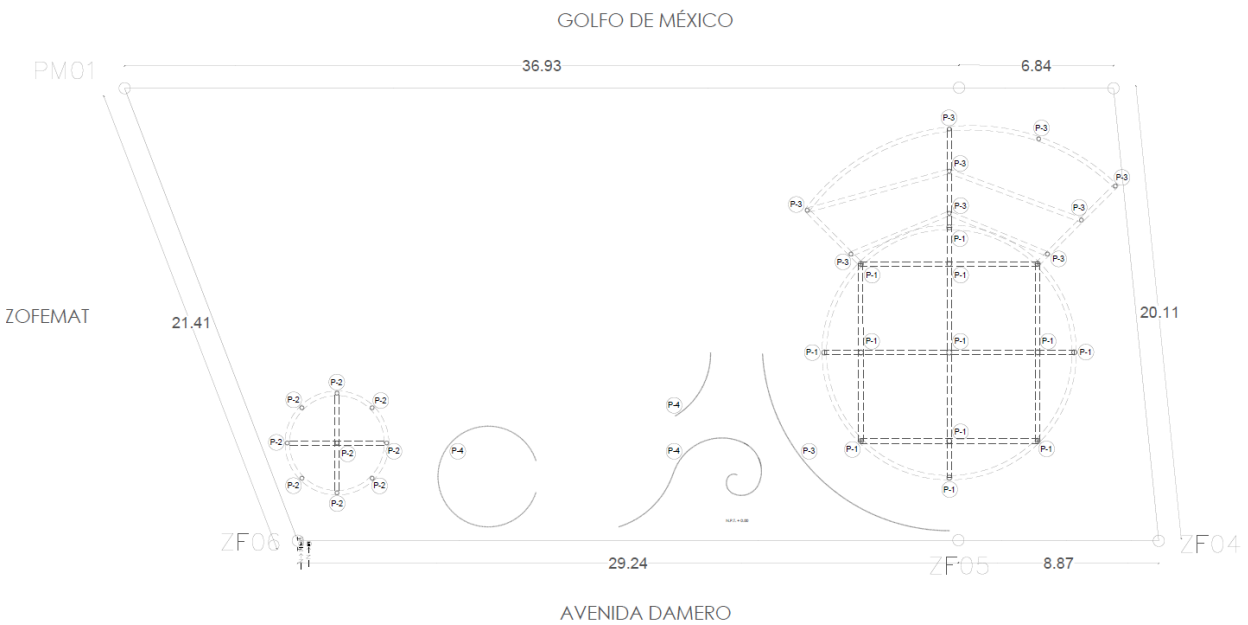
Desplante de los pilotes de las instalaciones que confirman el proyecto
